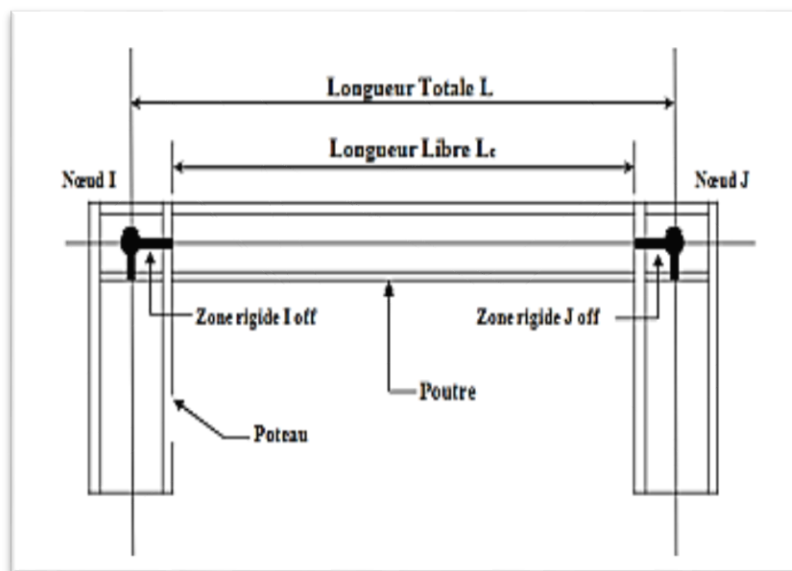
Attribution des Rigid end Offsets aux bouts des éléments poutres et poteaux.
